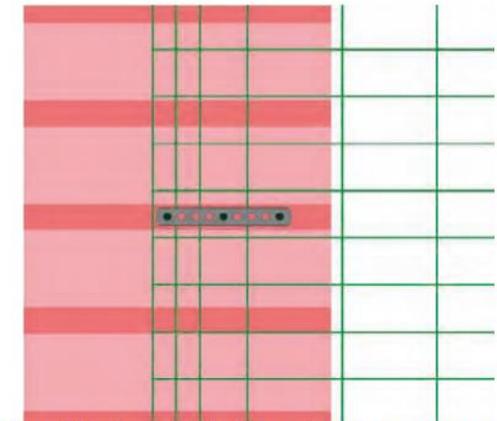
Dettaglio del fissaggio della rete con posa E (Schema impiegato nell’allestimento campioni per prova 4).
